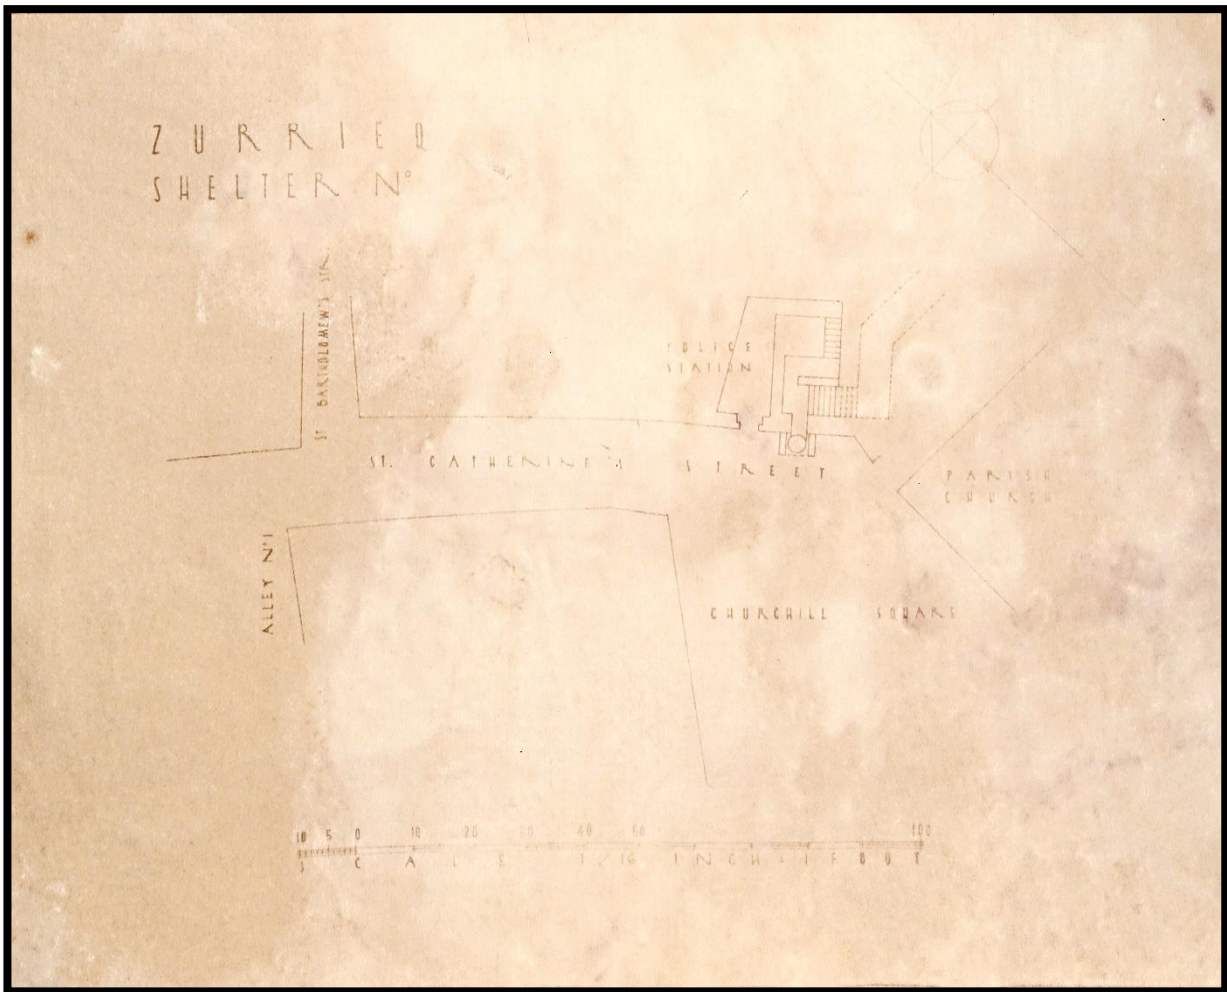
Planta do Abrigo "Alley nº1 – St. Bartholomew's Str*. – St. Catherine Street – Churchill Square"
